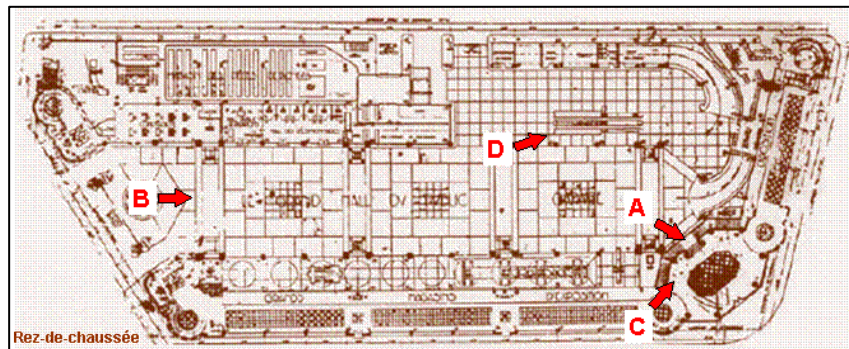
Plan du Rez-de-chaussée.⁴⁷
